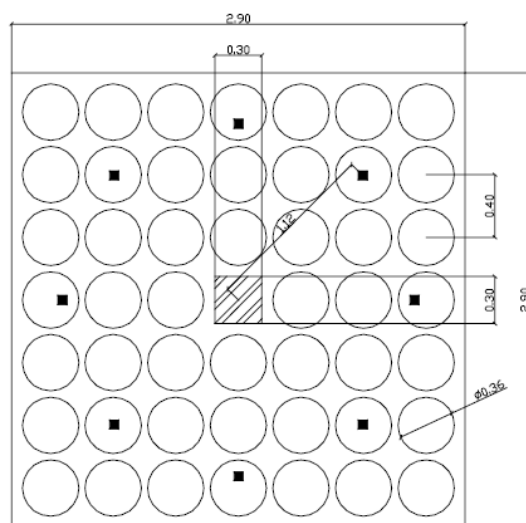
Lajes analisadas com 45 cm de espessura, vista em planta, [HELD (2002)]
